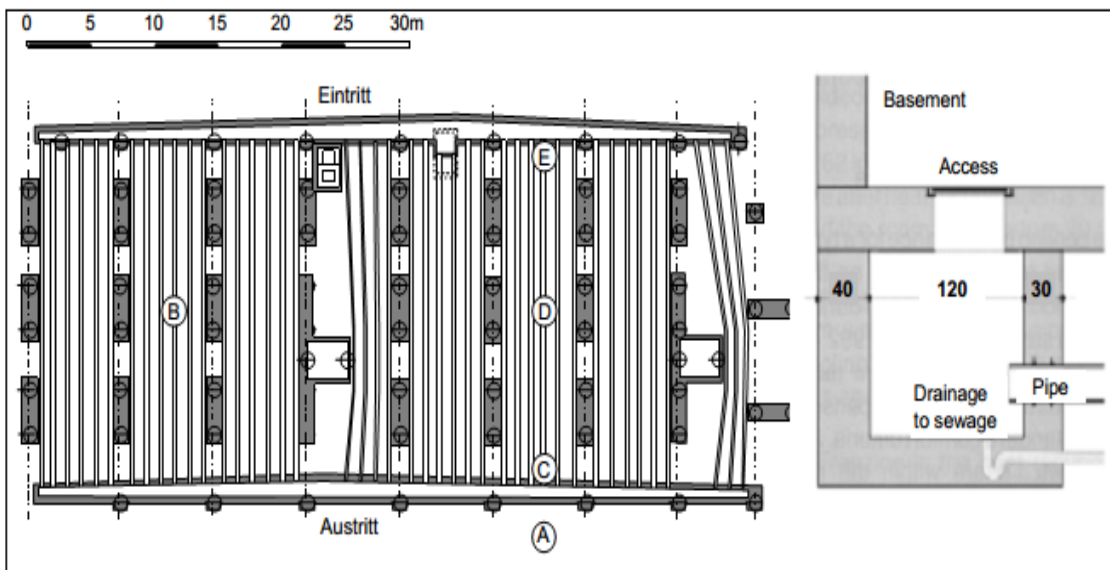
Schéma constructif du puits canadien de "Schwerzenbacherhof", plan et coupe de la nourrice
